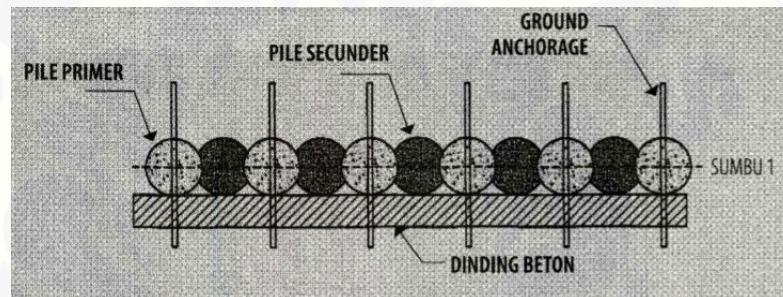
Secant Pile* Bersumbu 1 Dengan Tulangan Pada Pile Primer
